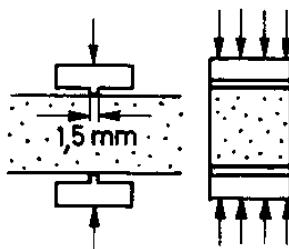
Provkropp av ett murverk, där mätutrusningen placeras enligt figur (SS EN 1052-1, 1998).
